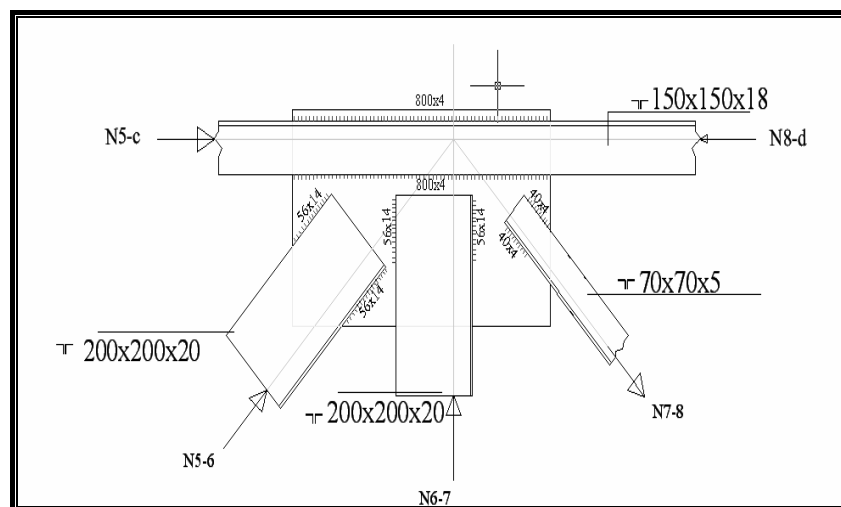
Schéma constructif des nœuds 2, 6, 10, 14, 18, 22, 26, 30
